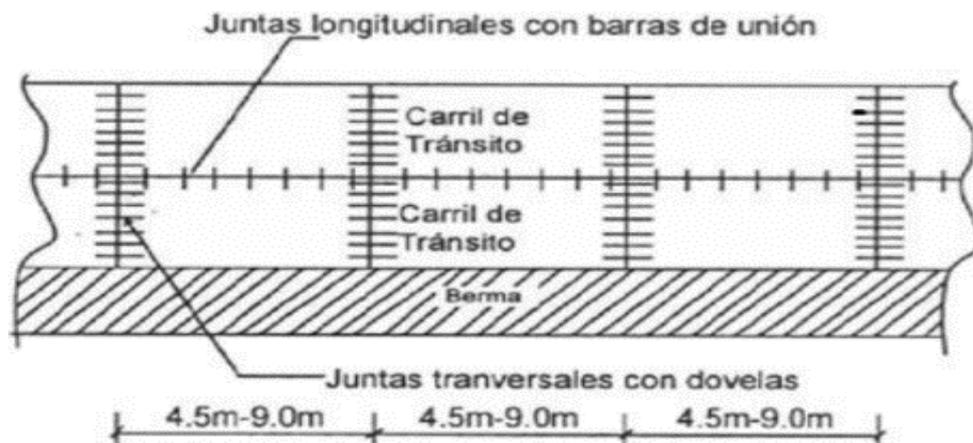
La composición del pavimento articulado de concreto simple. [15]
